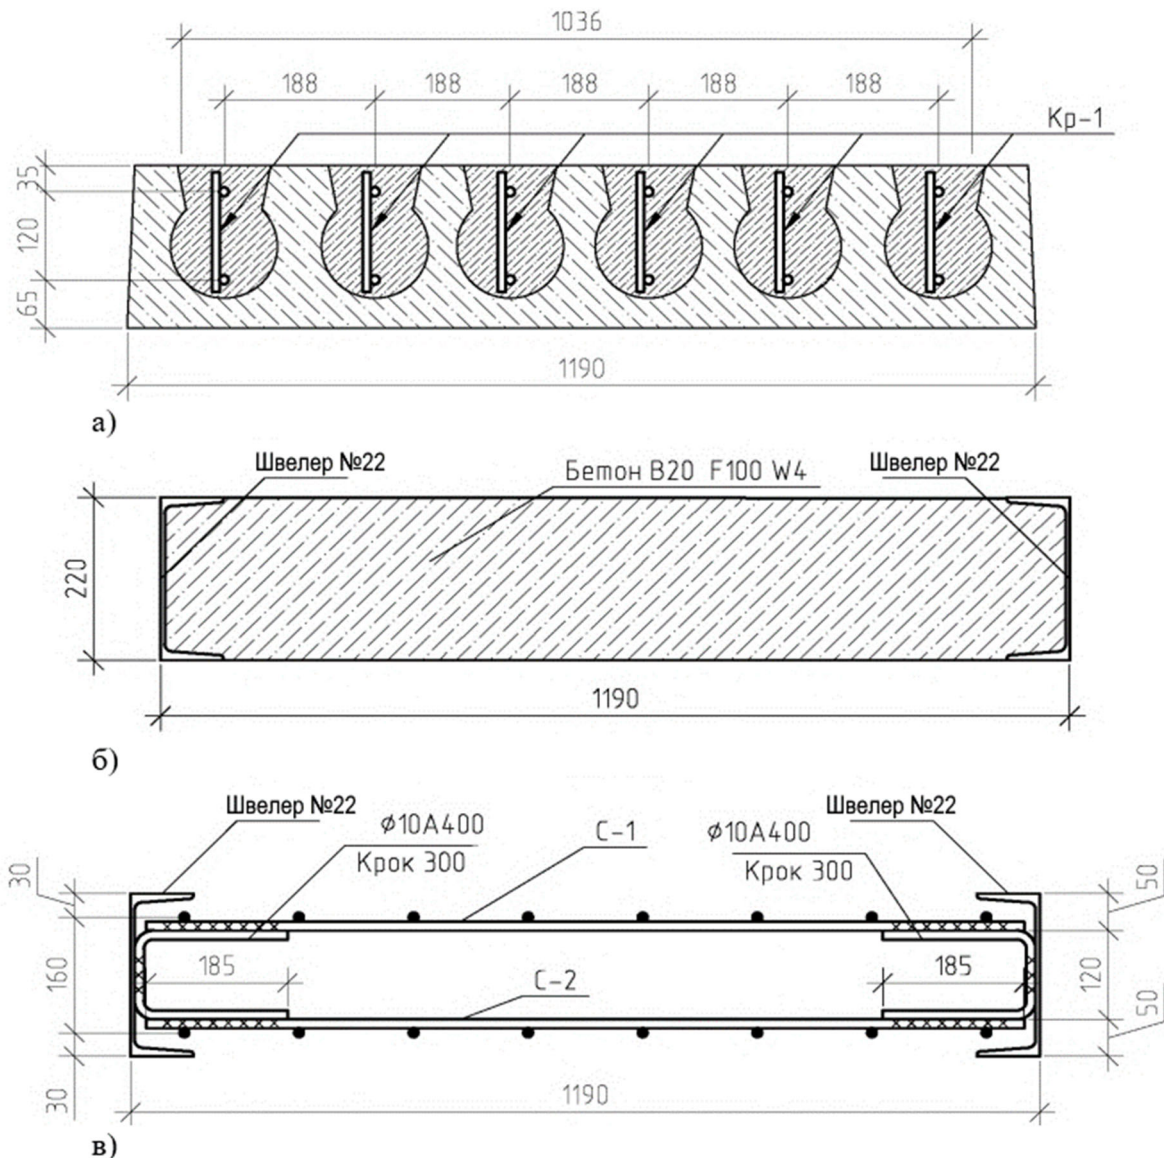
Підсилення збірних багатопустотних залізобетонних плит перекриття: а) влаштуванням арматурних каркасів в пустотах плит; б) влаштування монолітної ділянки замість плити перекриття; в) арматурний каркас монолітної ділянки
